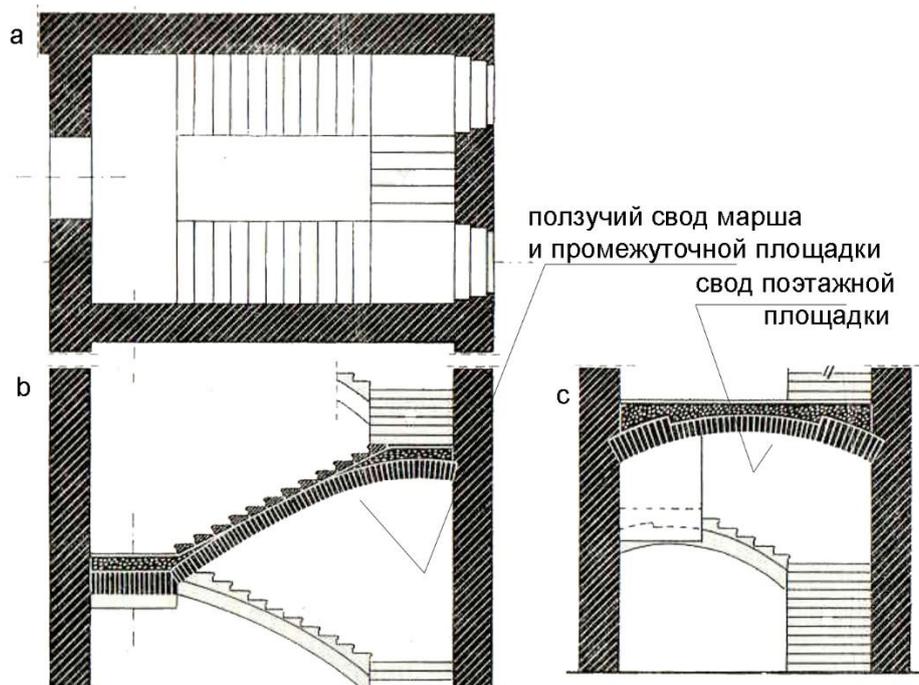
Лестница трехмаршевая на ползучих сводах: а – план; б – продольный разрез; с – поперечный разрез по поэтажной площадке [33]
